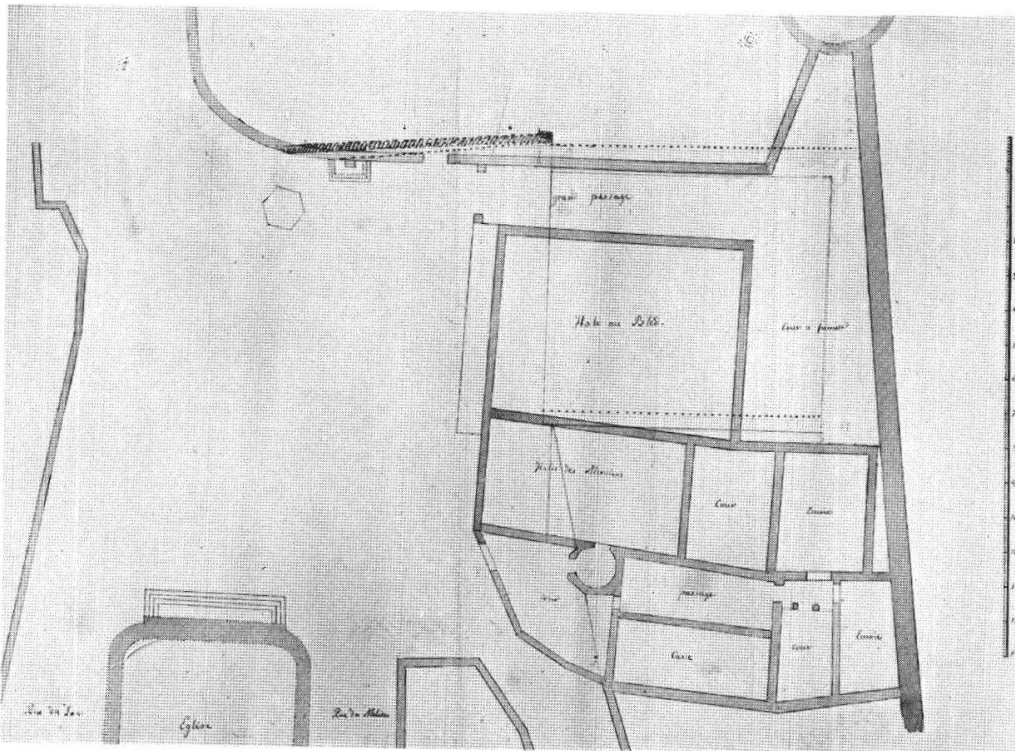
Yverdon – Plan de la Place, des halles et de la maison de ville, vers 1765 (AC Yverdon).
